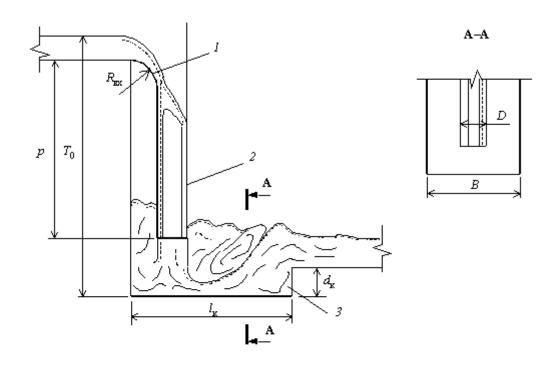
Схема к расчету трубчатого перепада 1 – входная воронка; 2 – стояк; 3 – водобойный колодец
